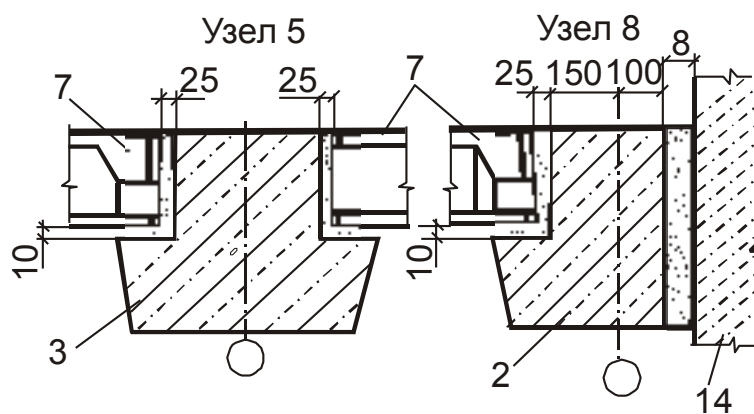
Детали сечений сопряжений несущих конструкций:
